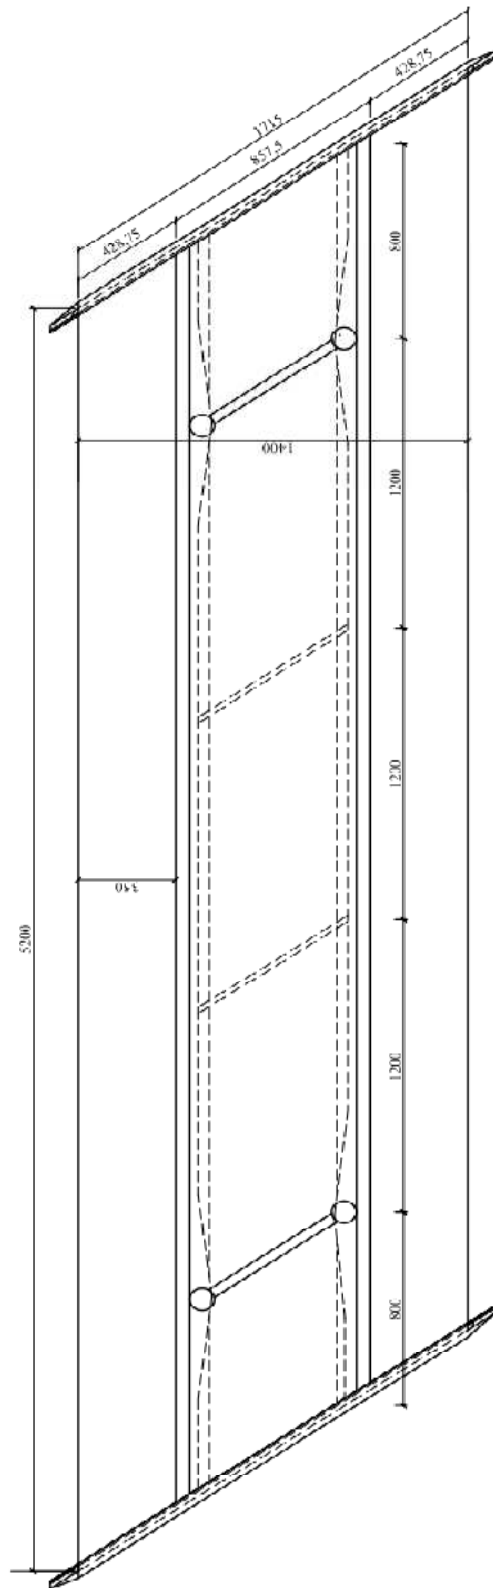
Vista em planta da ponte em seção celular (adaptado de CONTROLLATO, 2010a). Dimensões em cm.
